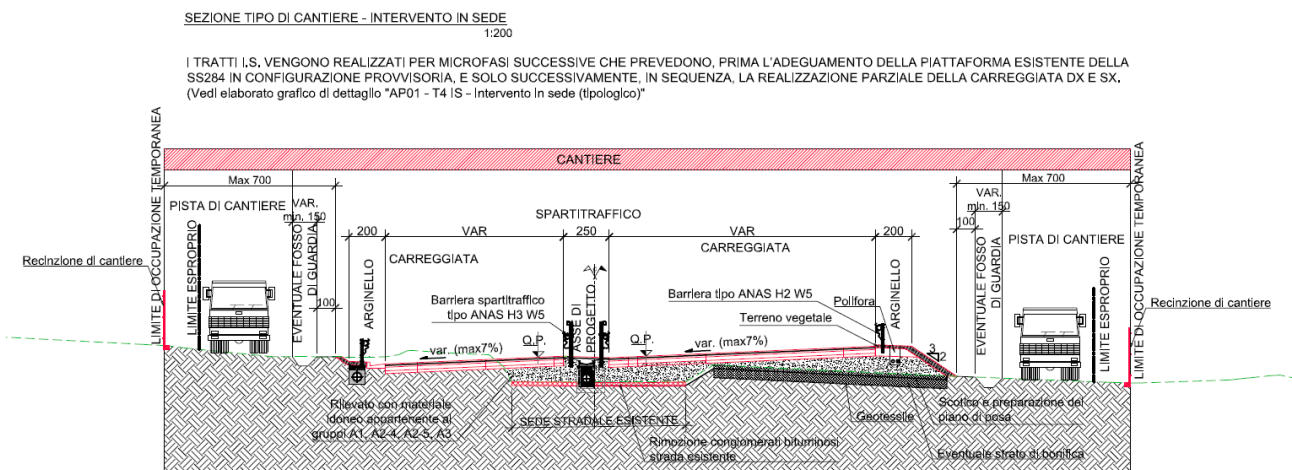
Intervento IN SEDE (I.S.) – Sezione trasversale tipologica di cantierizzazione
